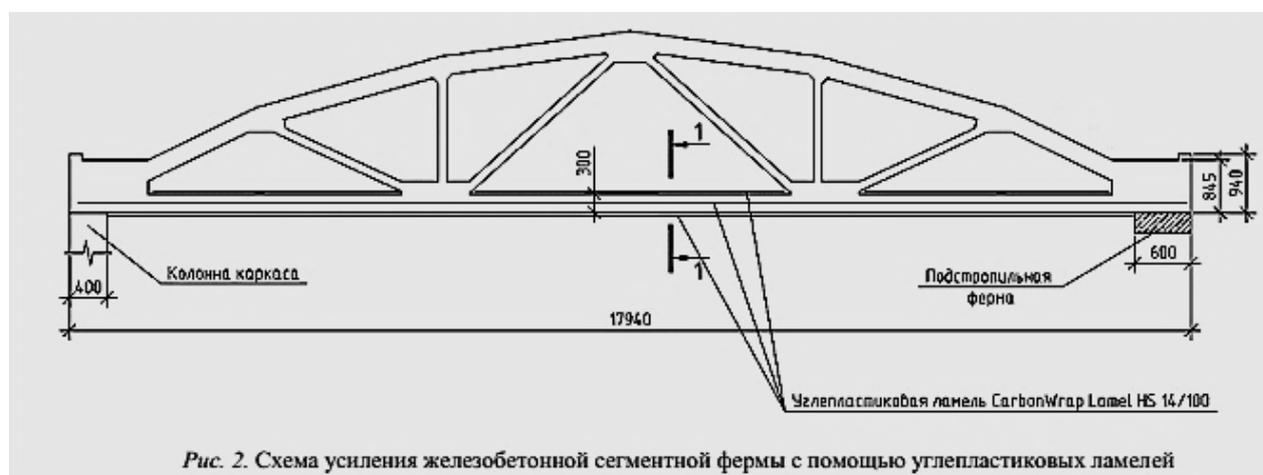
Схема усиления железобетонной сегментной фермы с помощью углепластиковых ламелей
